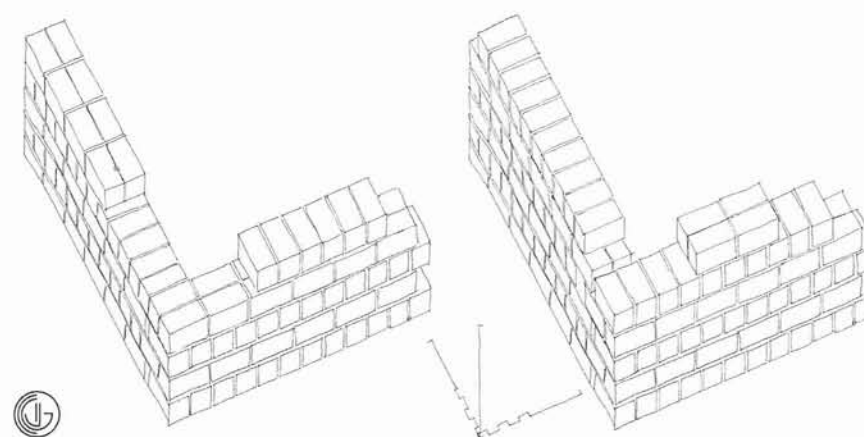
Proceso constructivo de un muro de adobe aparejado con una hilada a sogá y otra a tizón. Solución de la esquina
